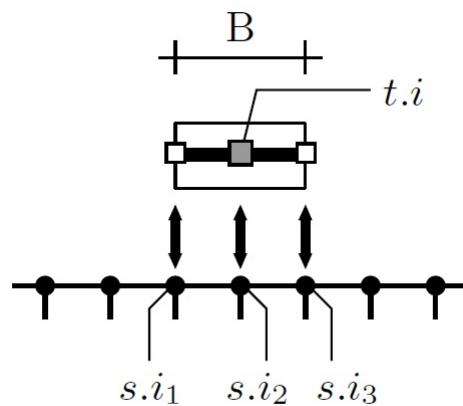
Vista na direção transversal da travessa da interação travessa-balastro (Varandas, 2013).
